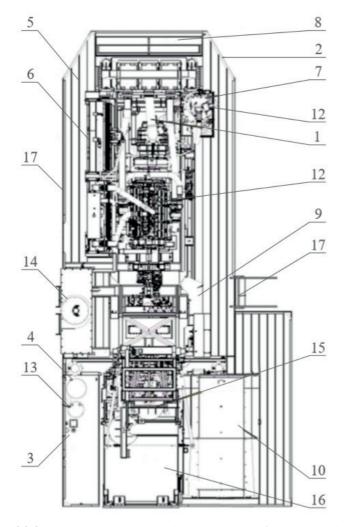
Основные узлы и механизмы буровой установки: 1 – топливный бак; 2 – панель быстрой заправки; 3 – погружная смазка; 4 – централизованная смазка; 5 – подогреватель двигателя системы смазки; 6 – блок охладителя; 7 – приемный резервуар компрессора; 8 – коробка батарей; 9 – тушение пожара; 10 – кабина установки; 11 – бак на 600 галлонов; 12 – насос воды; 13 – резьбовая смазка; 14 – система сбора пыли; 15 – центратор установки; 16 – платформа установки; 17 – стремянка установки для техобслуживания
